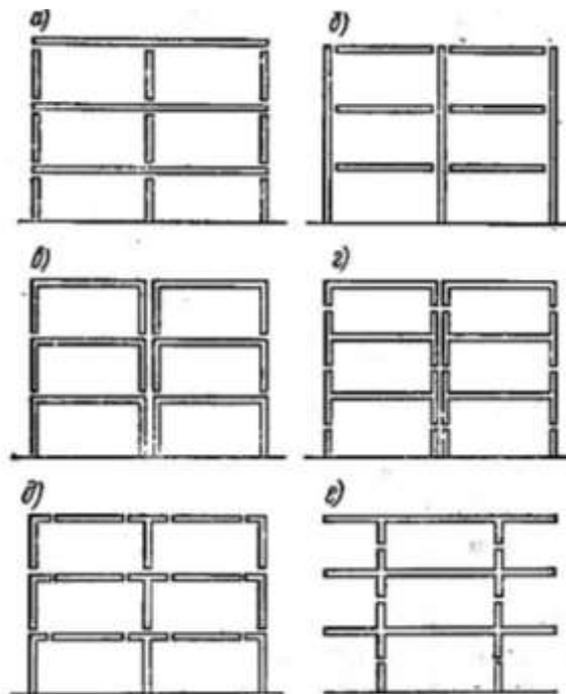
Схемы членения сборных железобетонных каркасов на составные элементы: а) – одноэтажные колонны и двух пролетные ригели; б) – многэтажные колонны и однопролетные ригели; в) – П-образные рамы; г) – Н-образные рамы; д) – тавровые и Г-образные колонны и ригели – вставки; е) – Н-образные рамы при консольной схеме [4]
